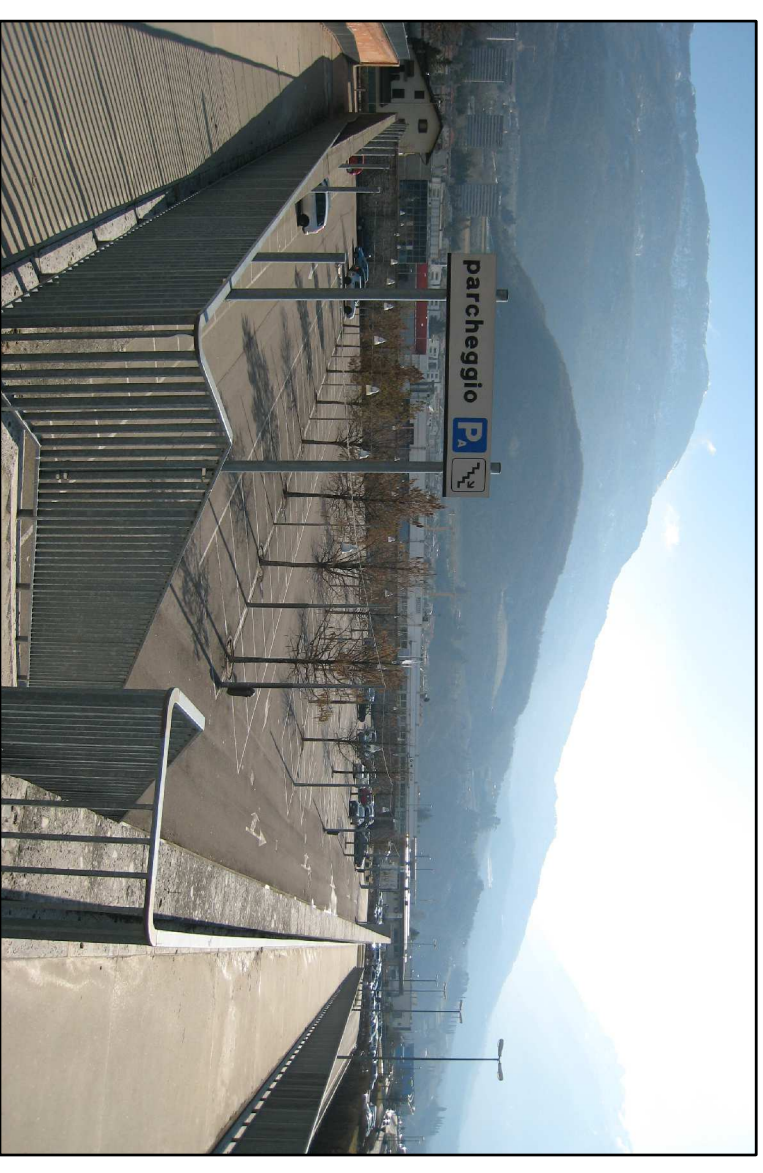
Area per il parcheggio di autoveicoli a servizio del Palazzetto dello sport.
